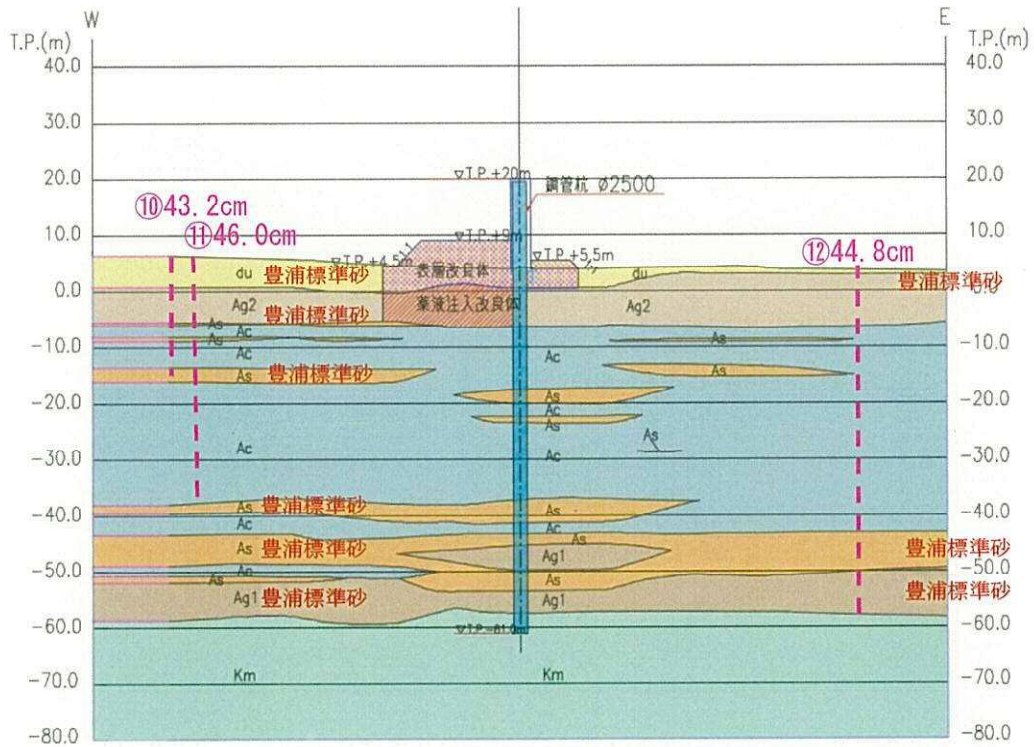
(9/10) 鋼管杭鉄筋コンクリート防潮壁断面図 (2次元有効応力解析)
